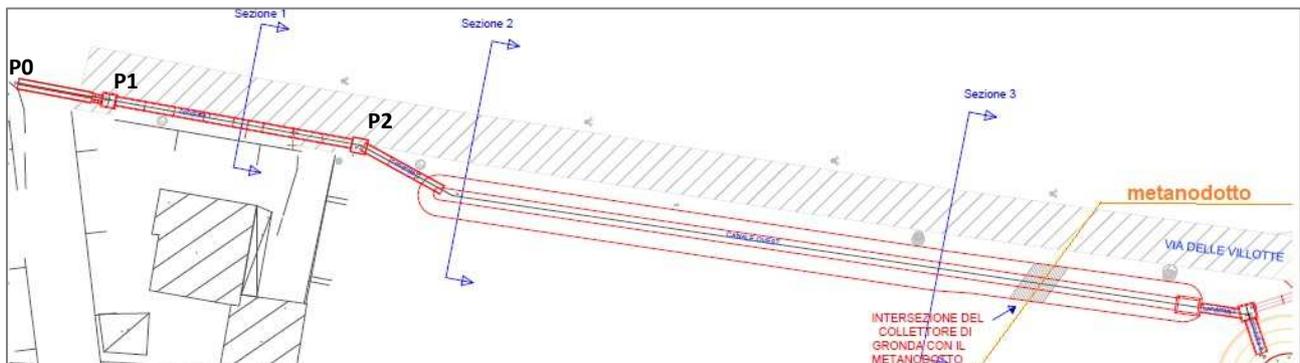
Collettore di gronda: planimetria di progetto, LATO OVEST
